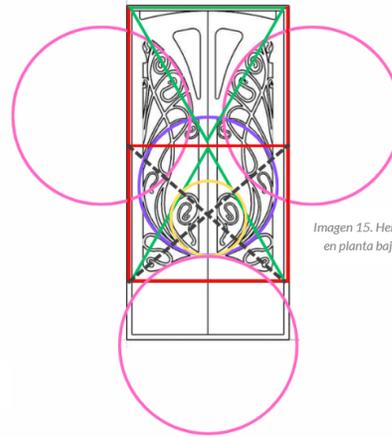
Herrería en puerta en planta baja. [Sketchup].
